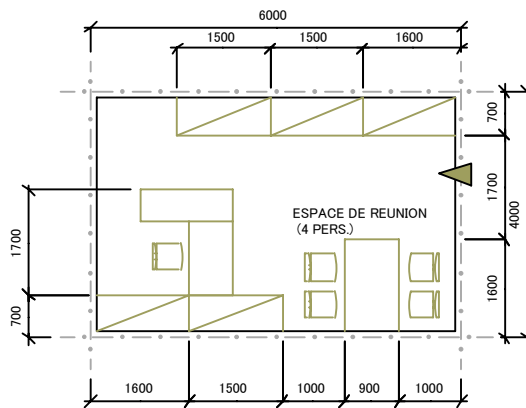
Plan planimétrique du bureau de comptabilité
